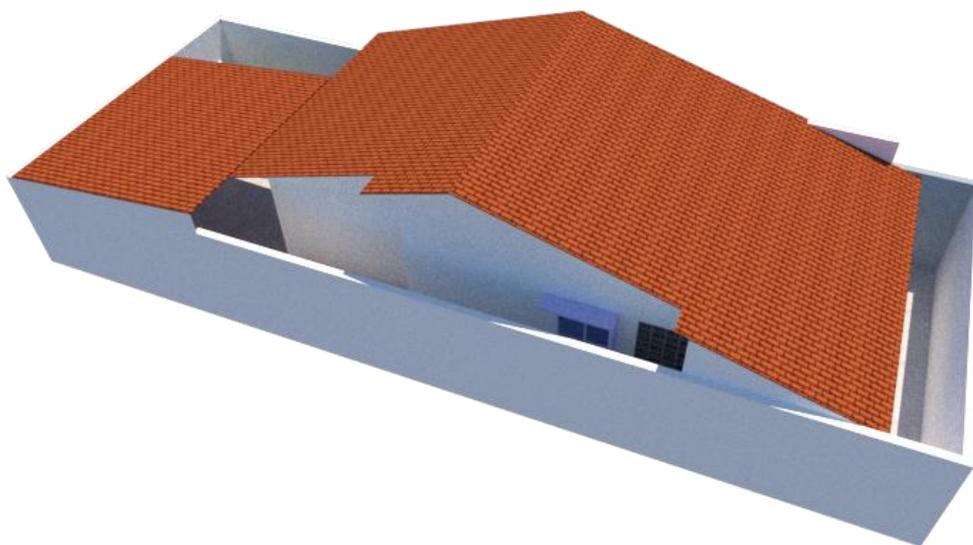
Proposta orientada à Sudeste - Fachada lateral
